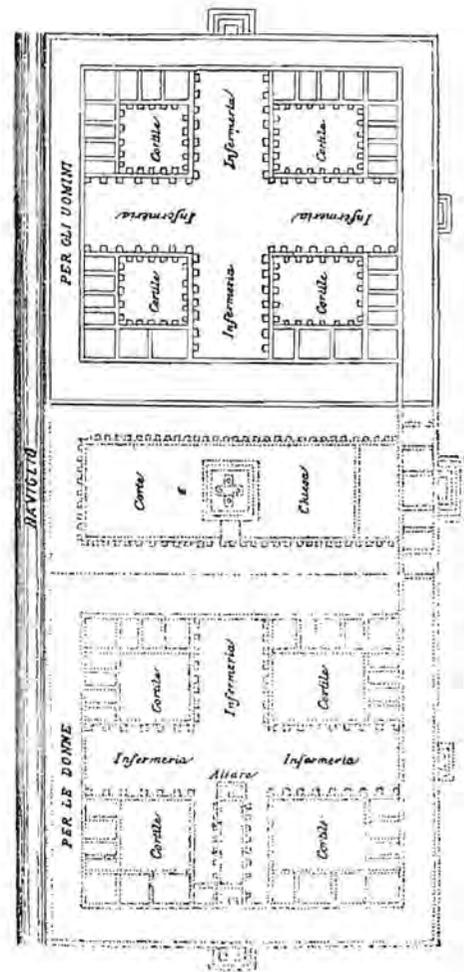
Pianta dell'Ospedale (progetto Filarete).
